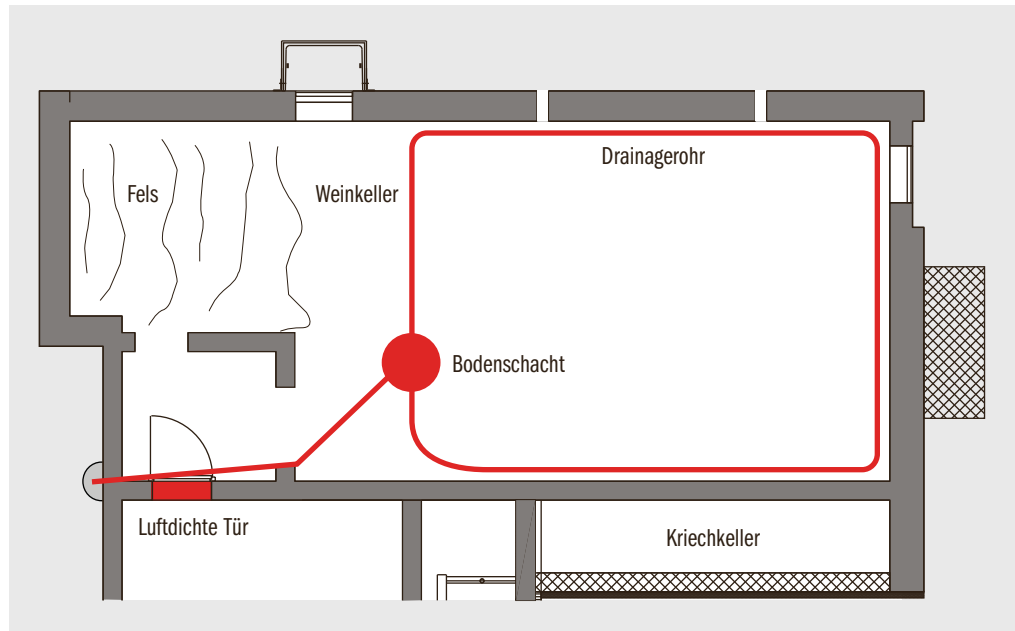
Grundriss des Weinkellers mit Drainage.
